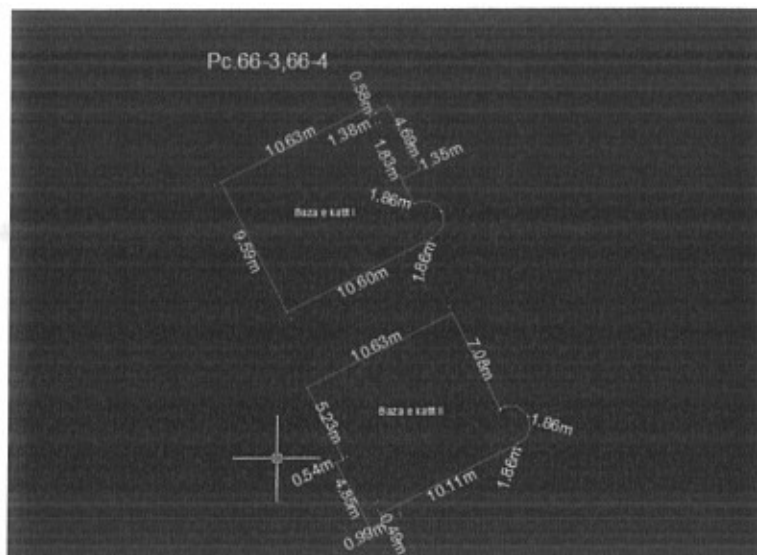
Sipërfaqja e katit të parë dhe të dytë marr nga Formularit i Inqizimeve të Strukturës
